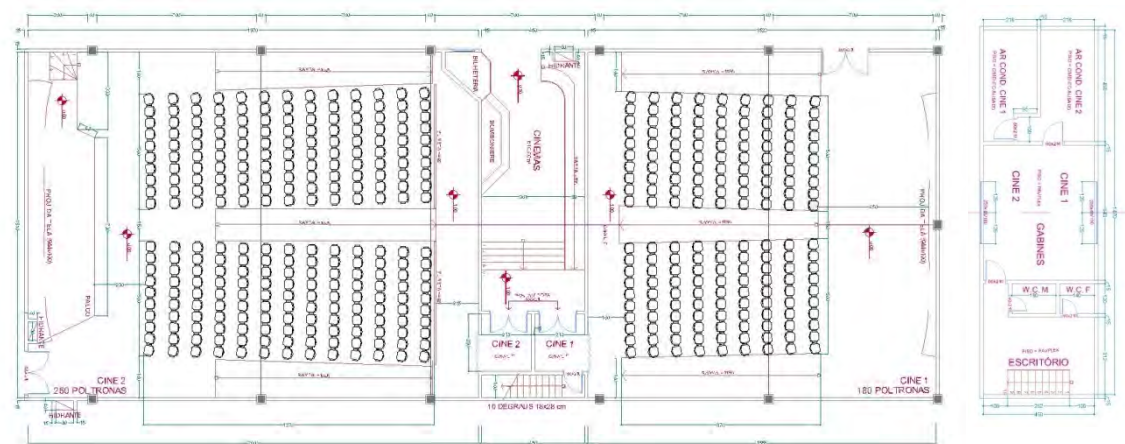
Planta Baixa Cinema Big Shopping Center e Planta Baixa Mezanino Técnico
